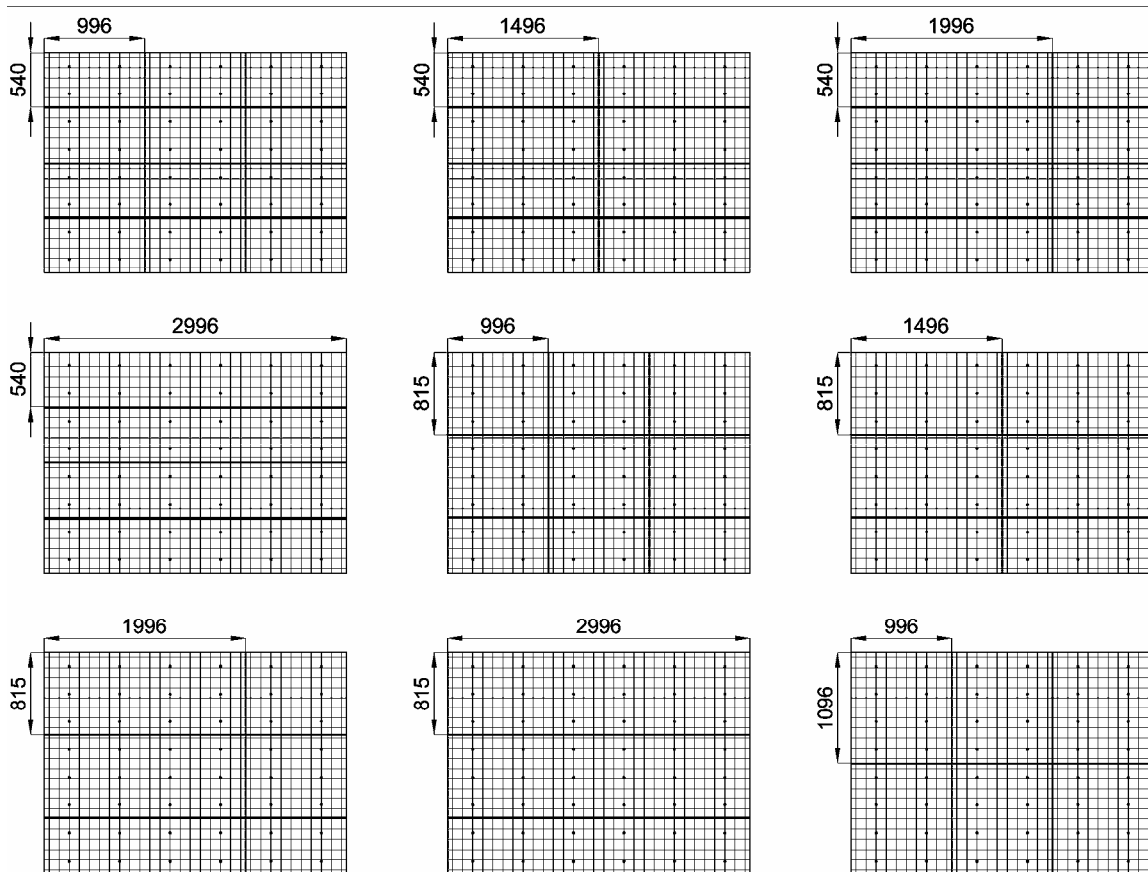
Cortes del panel estándar. Menores dimensiones.
